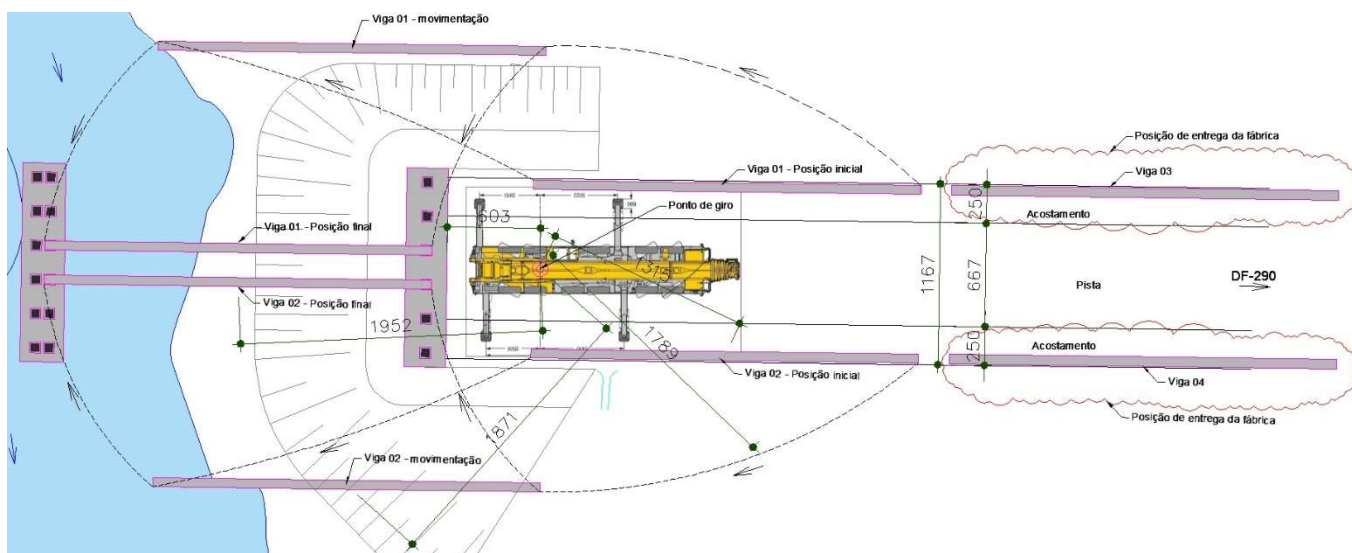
posição para movimentação e içamento das vigas pré-moldadas.
